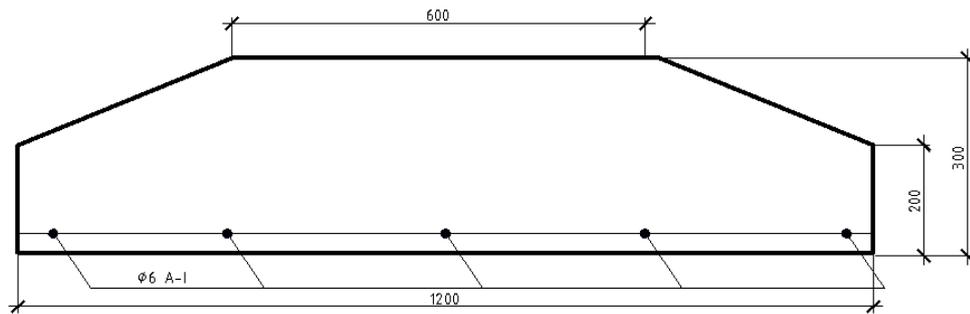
Конструкция плиты ленточного фундамента.
